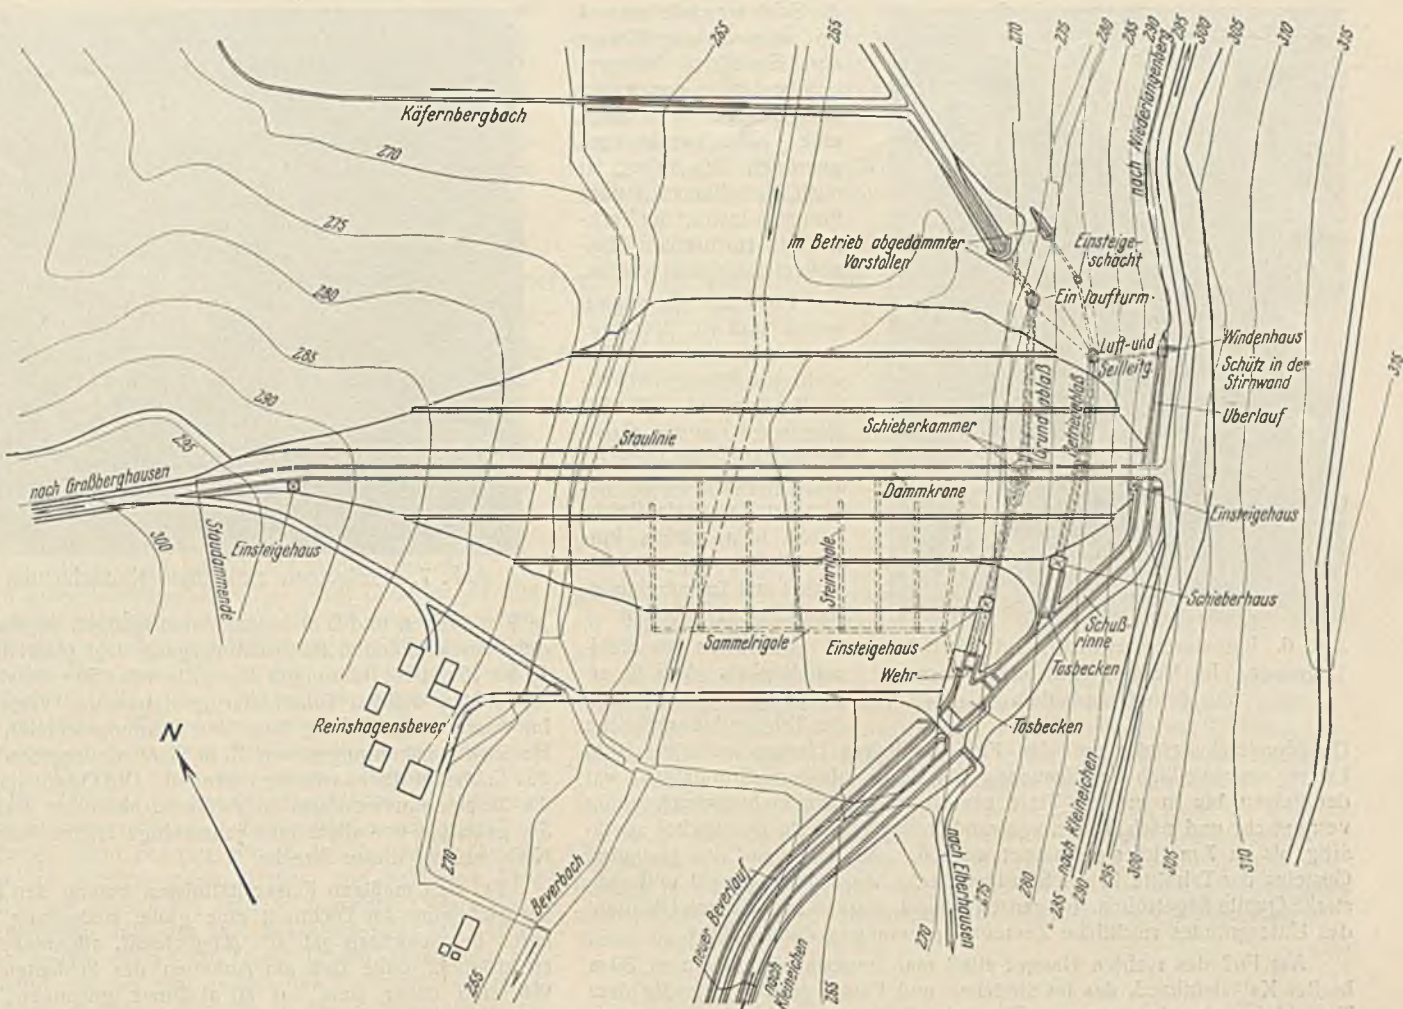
Lageplan des Dammes mit den Entlastungsanlagen.
